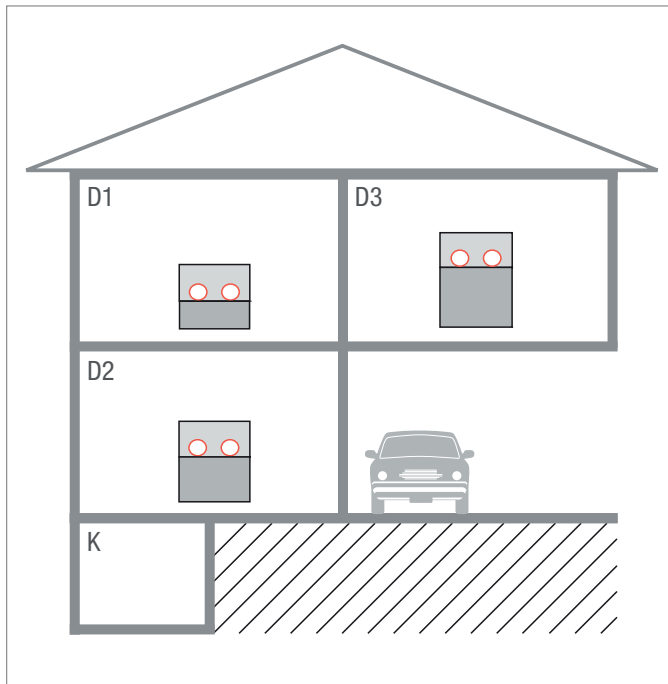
Estructura de las capas de aislamiento mínimas para el sistema RAUTHERM SPEED plus.
